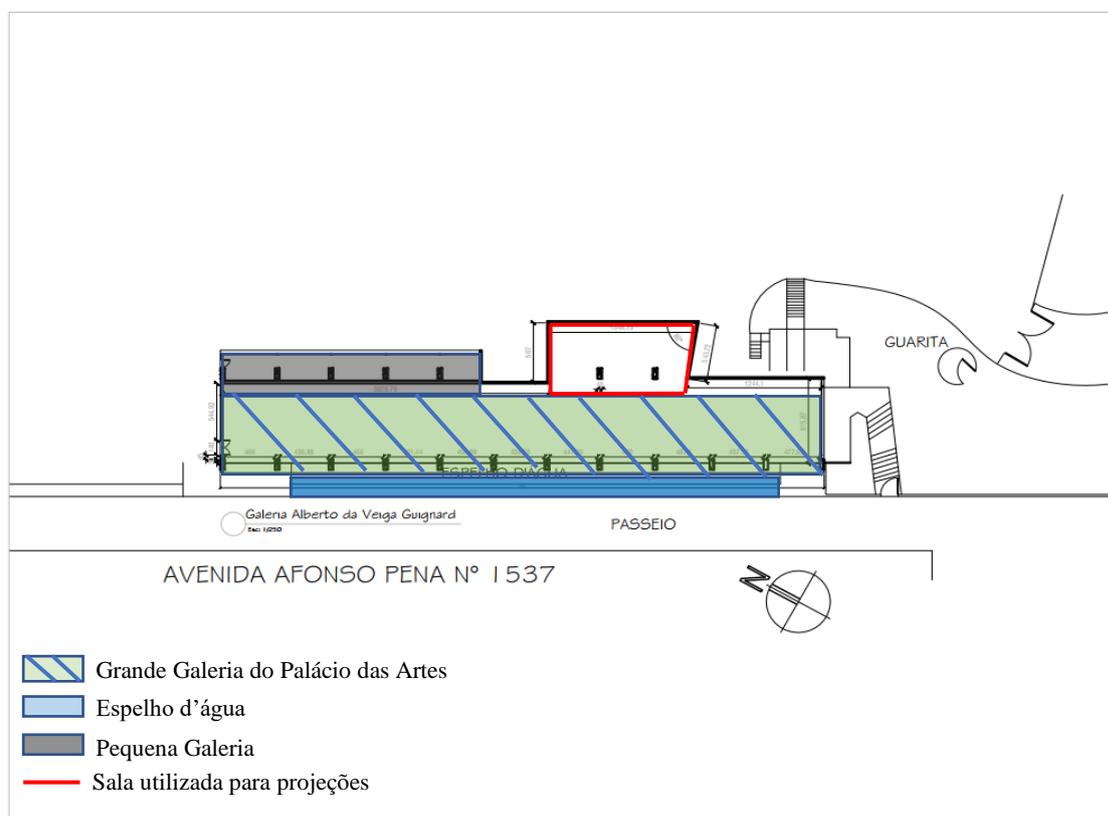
Planta com setorização da Grande Galeria do Palácio das Artes – adaptação da autora.
